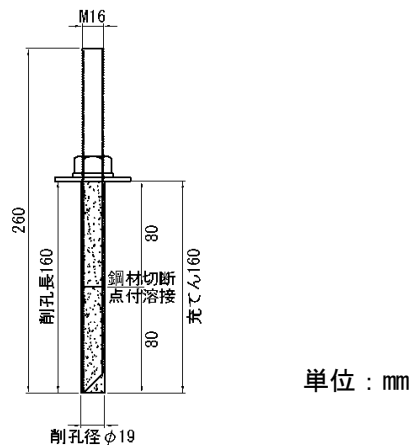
あと施工アンカー施工図（鋼材破断）
